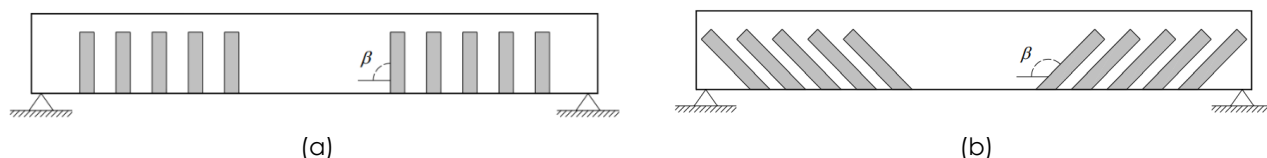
Disposizioni nastri per rinforzo a taglio: a) perpendicolari all'asse della trave, b) inclinati rispetto all'asse della trave.
